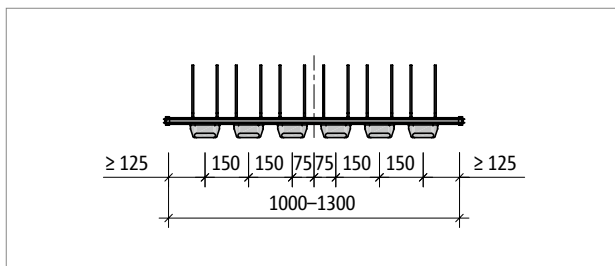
Schöck Tronsole® Typ T-V6-...-L1000 bis L1300: Produktgrundriss
